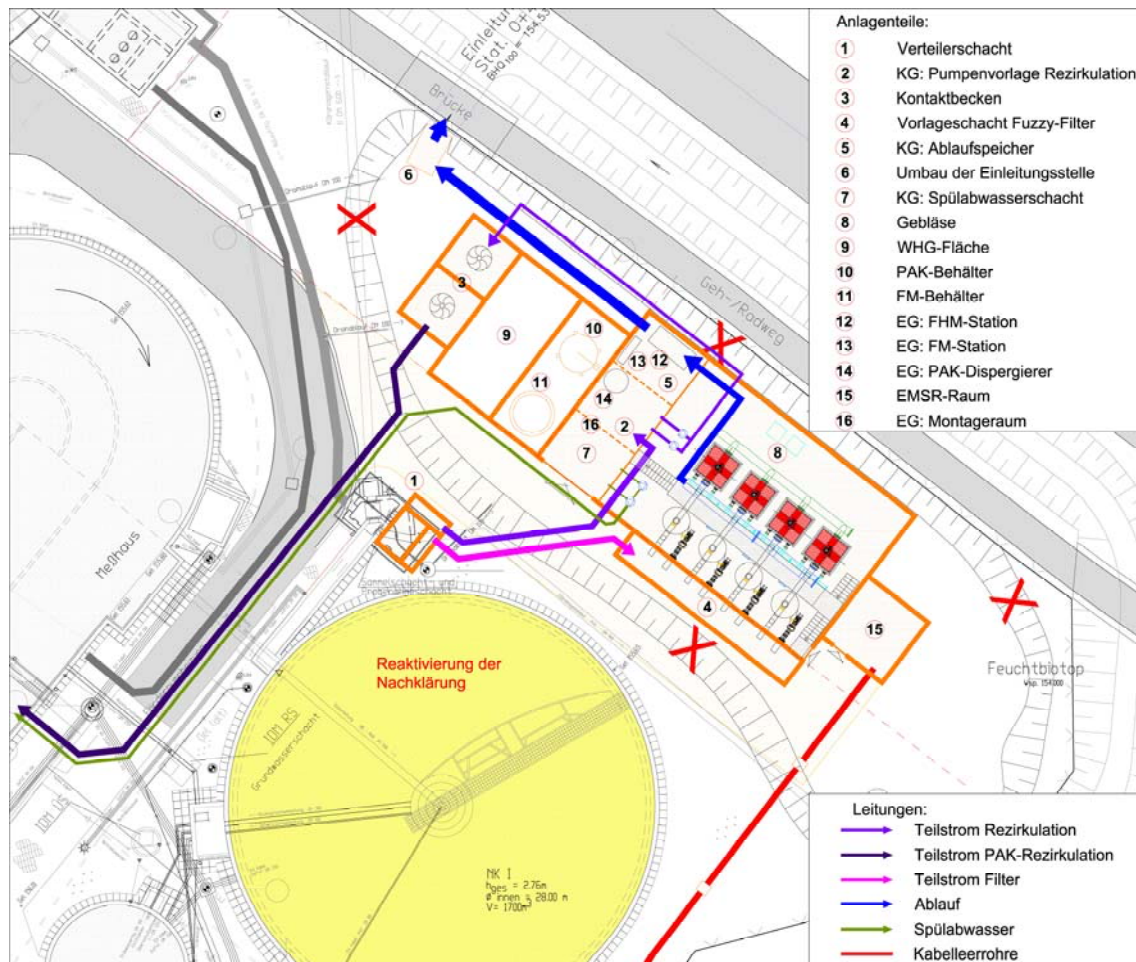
Lageplan KA Barntrup - Variante III - PAK-Kontaktbecken (Rezirkulationsbetrieb)
